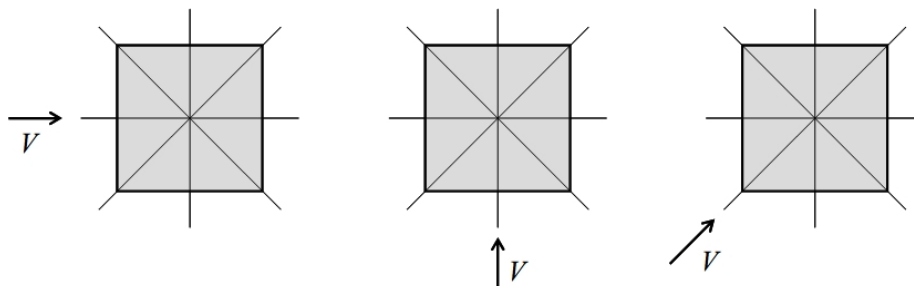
Direcția vântului de proiectare pentru structuri pătrate în plan [1]
